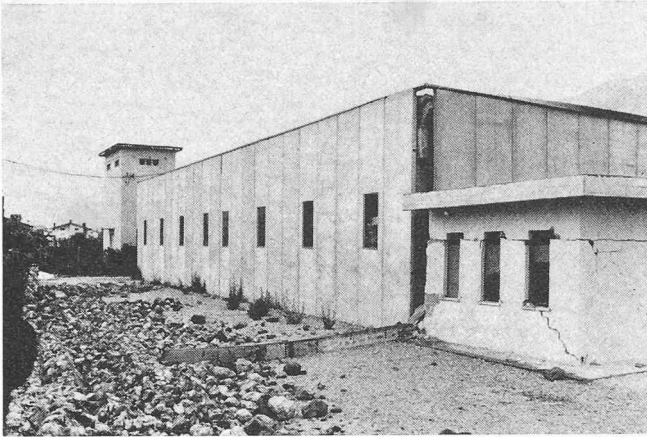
(nach dem 6. Mai). Links: Vorfabrizierte Halle mit Backsteinanbau in Gemona. Das Tragskelett der Halle ist unbeschädigt, dagegen wurden die Betonelemente der Seitenwand beim Aufprall an den steifen Anbau leicht eingedrückt. Die Kunststoffmasse der Wandfugen wurde infolge der grossen Verformungen zerrissen. Das Dach des Anbaues ist durch die Impulsbelastung des Anpralls infolge ungenügenden Bauwerkabstandes auf Fensterhöhe abgesichert und weggeschoben worden
